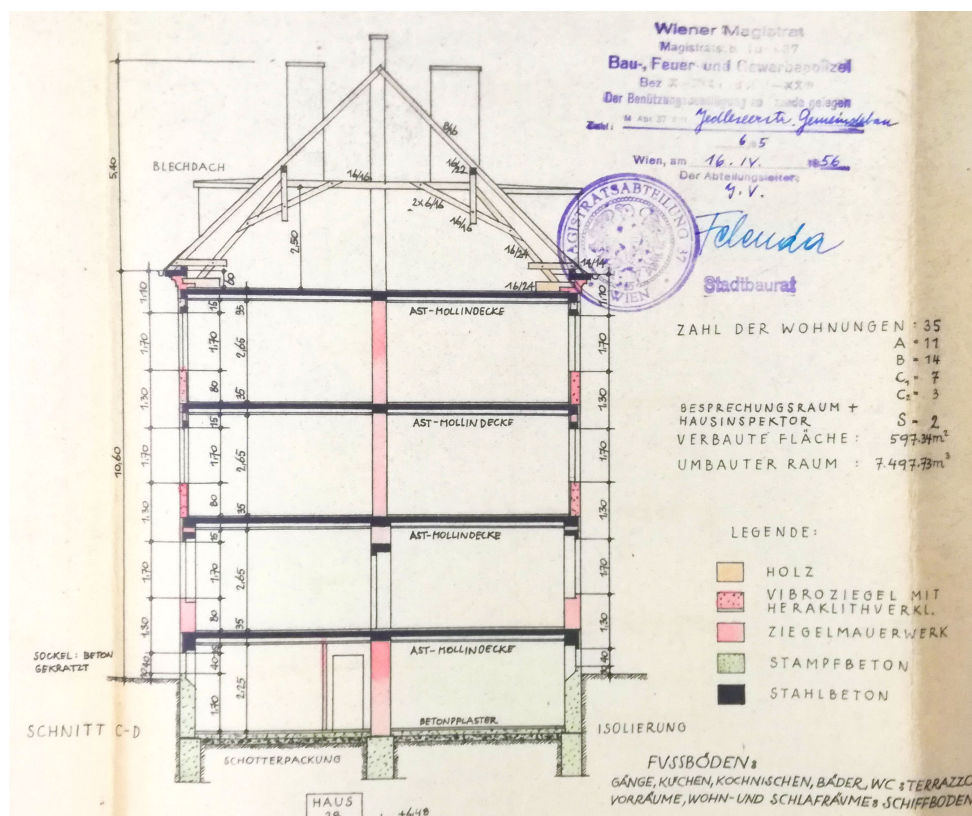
Typische Bauweise eines kommunalen Wohnbaus der Nachkriegszeit mit Stampfbetonmauerwerk im Kellerbereich - Wohnhausanlage Jedleseerstraße 21. Bezirk
